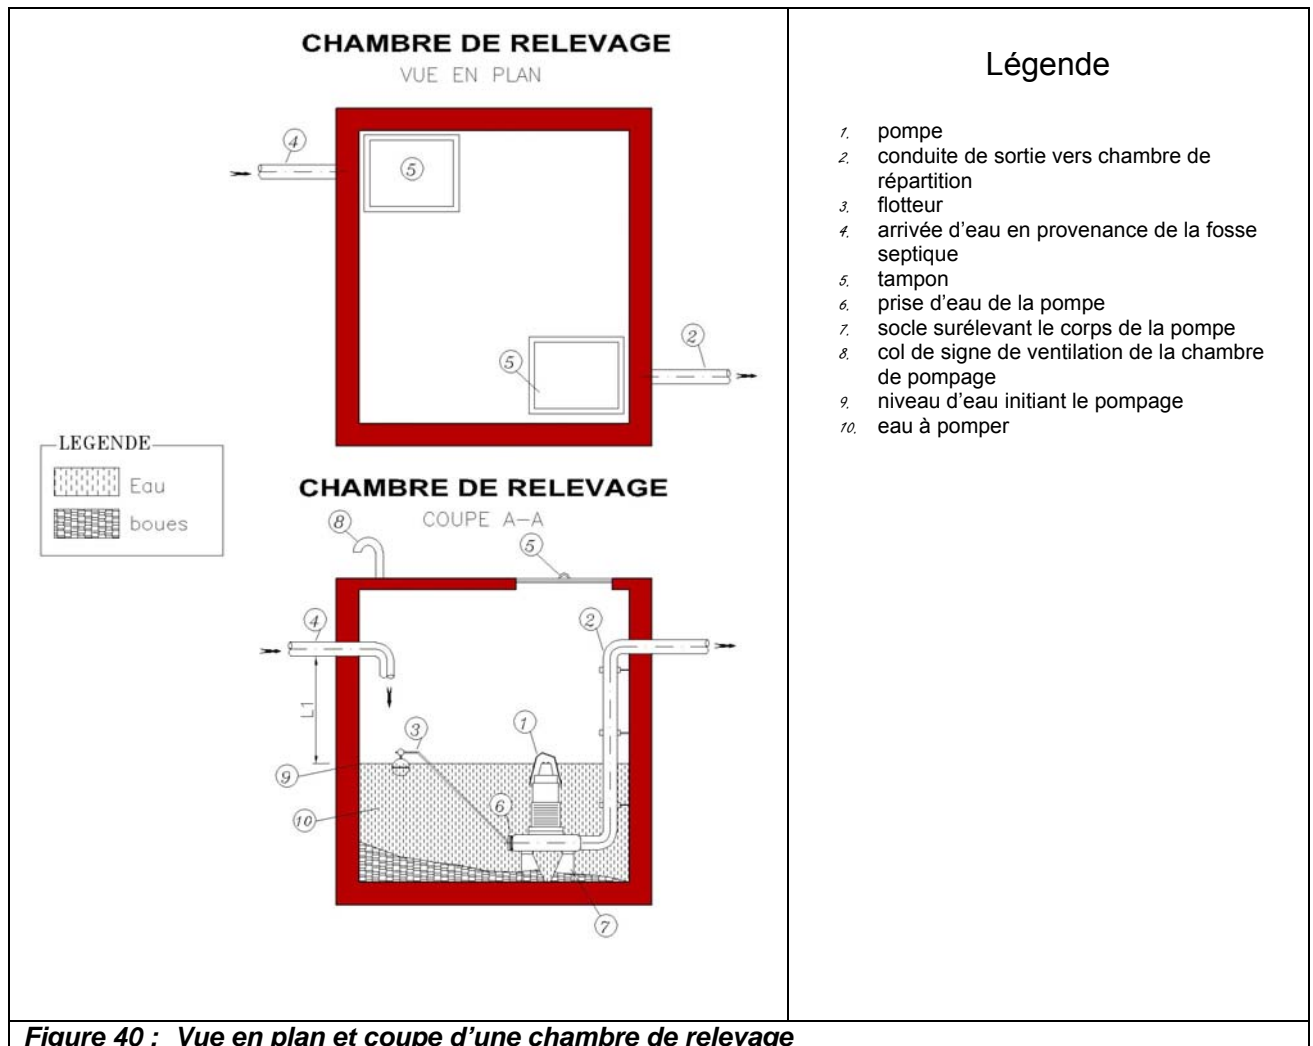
Vue en plan et coupe d'une chambre de relevage
